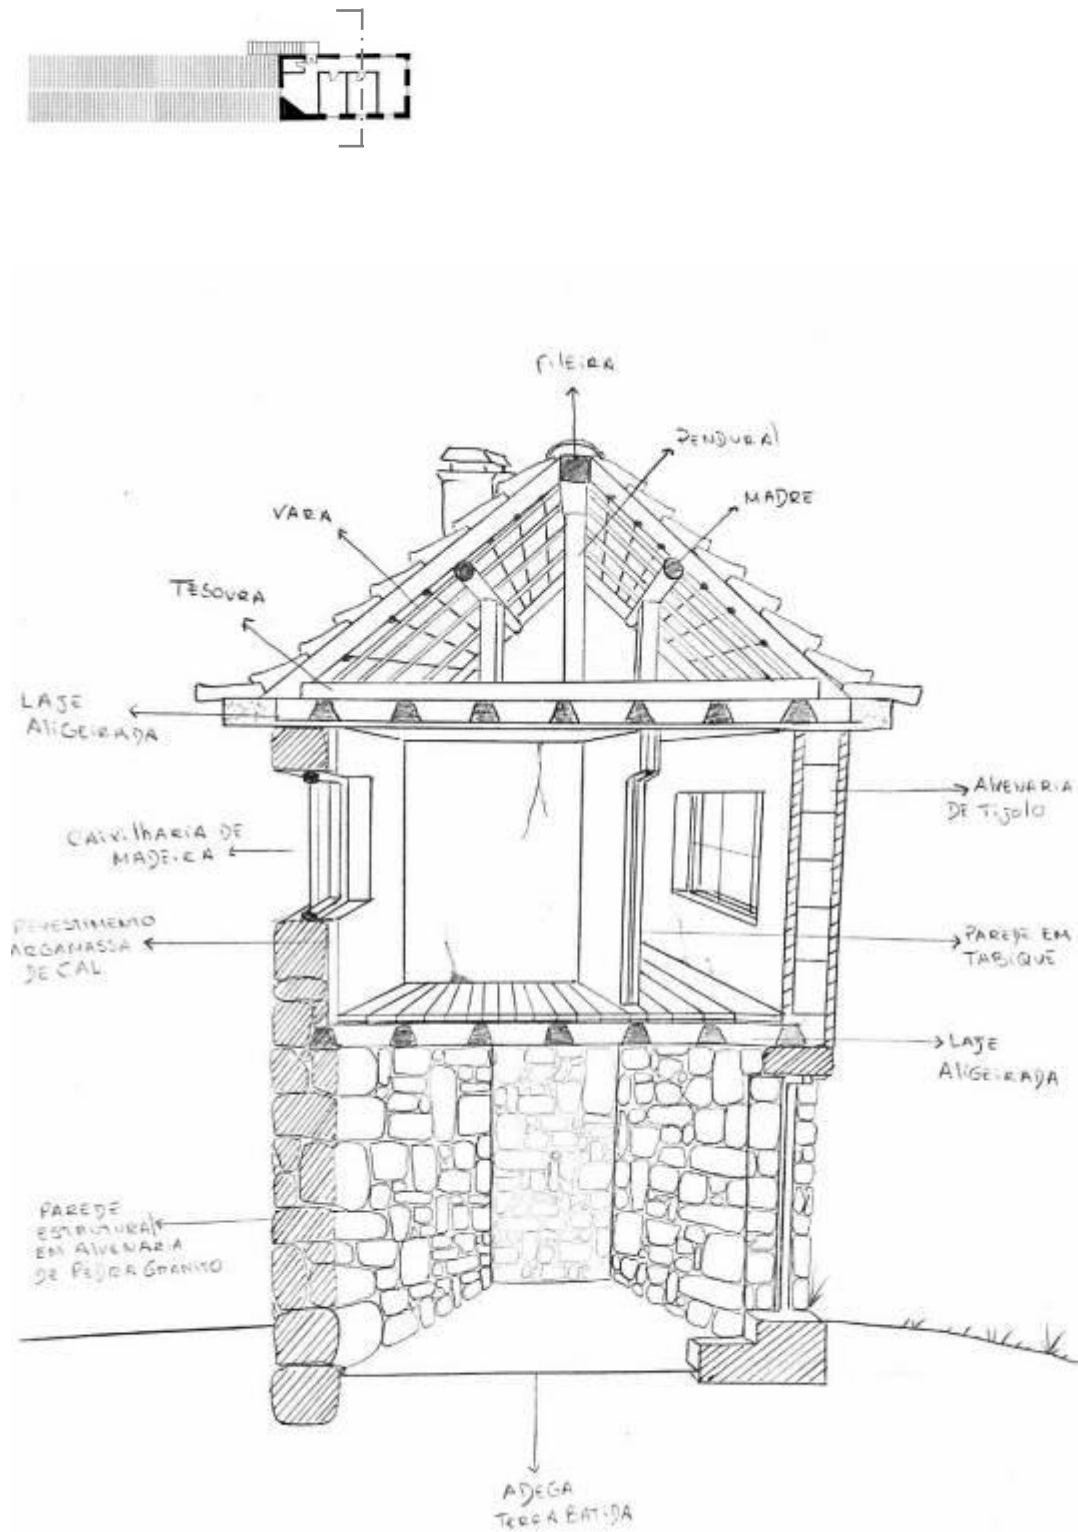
Análise sistemas construtivos, Casa da Cachada.
